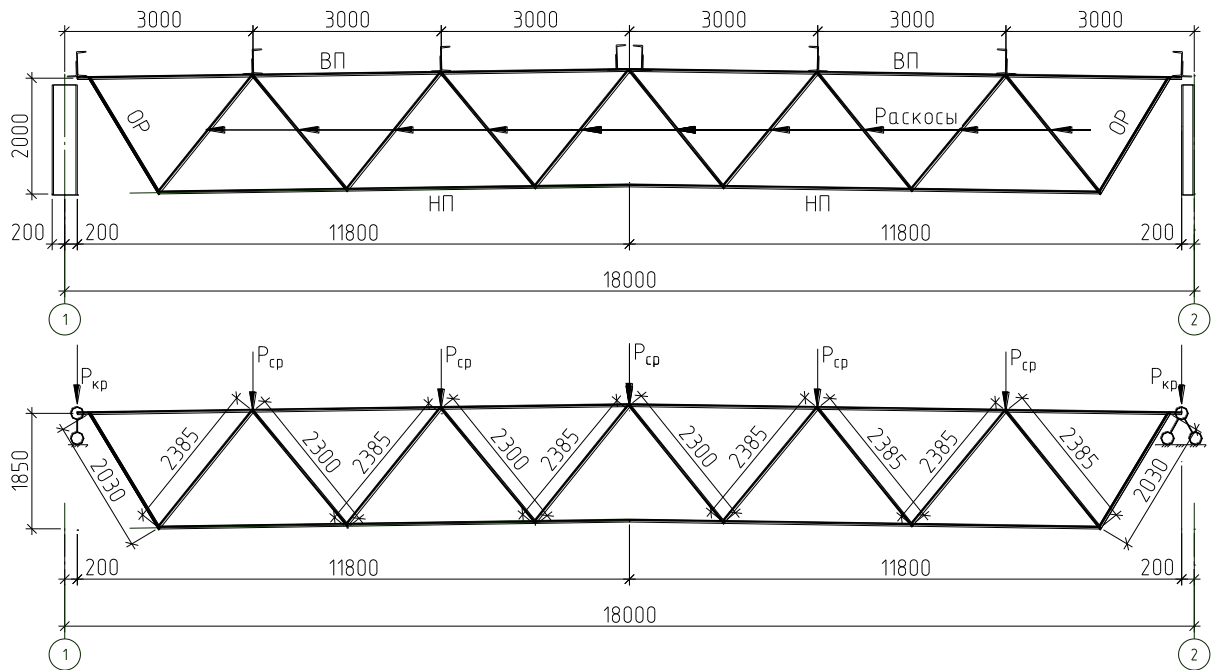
Конструктивная и расчетная схема фермы
